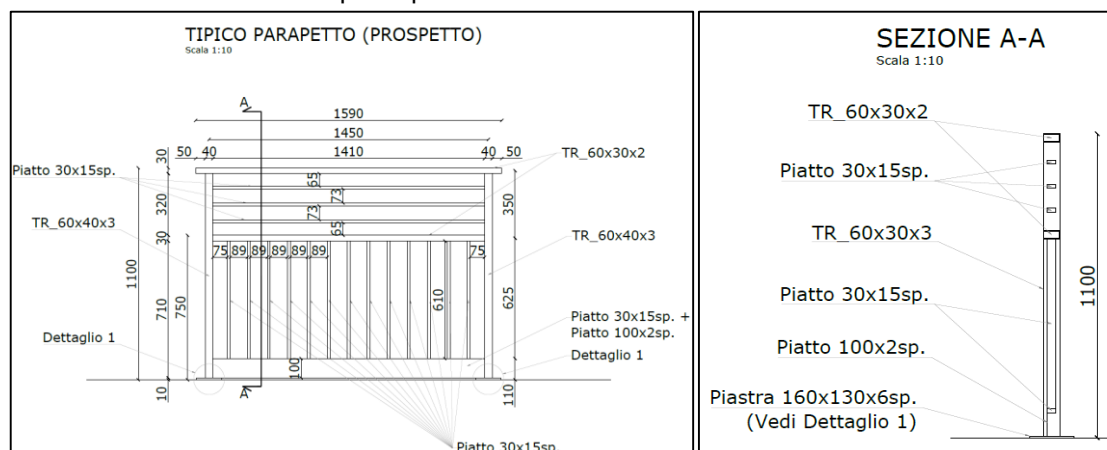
Sezione tipica parapetto (si rimanda alle tavole di progetto per maggiori dettagli)
